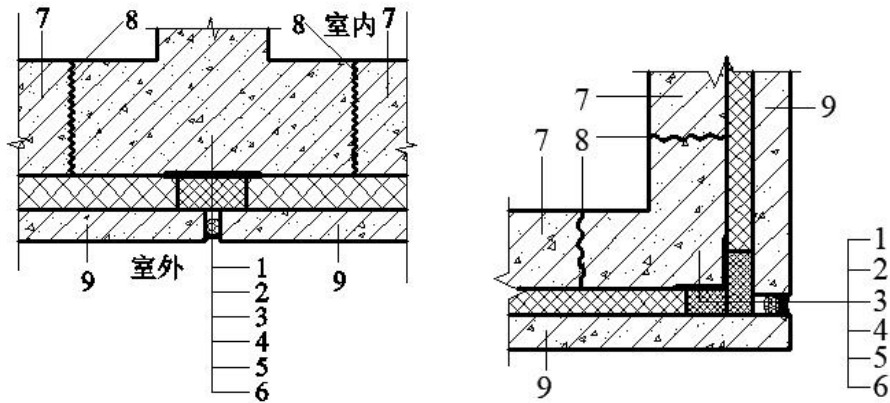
预制混凝土夹心剪力墙水平接缝防水构造
